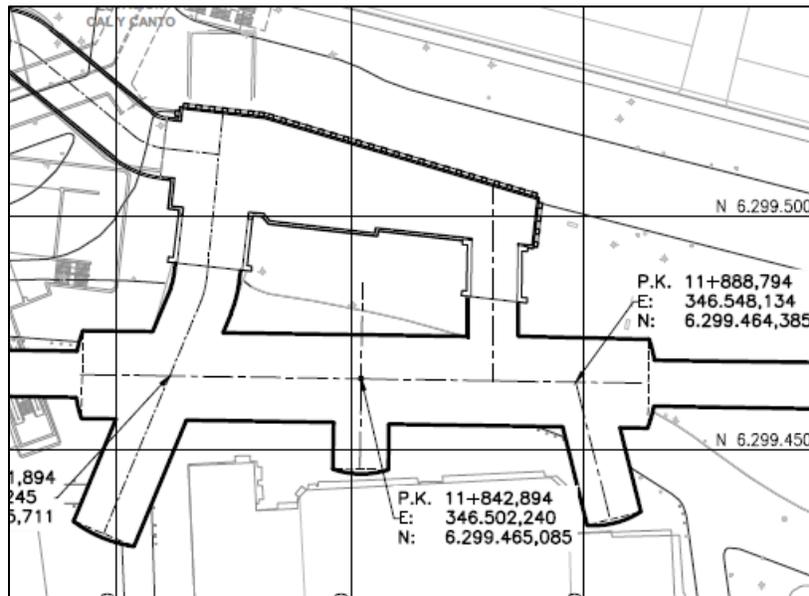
Planta Emplazamiento Pique Principal de Estación Cal y Canto
